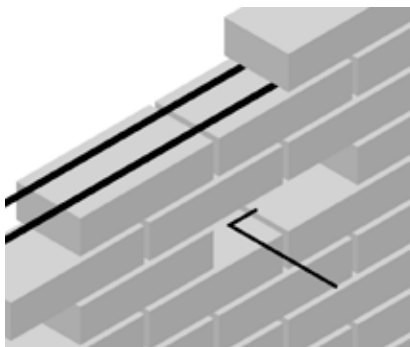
Närbild på armeringens och kramlans placering i muren.
